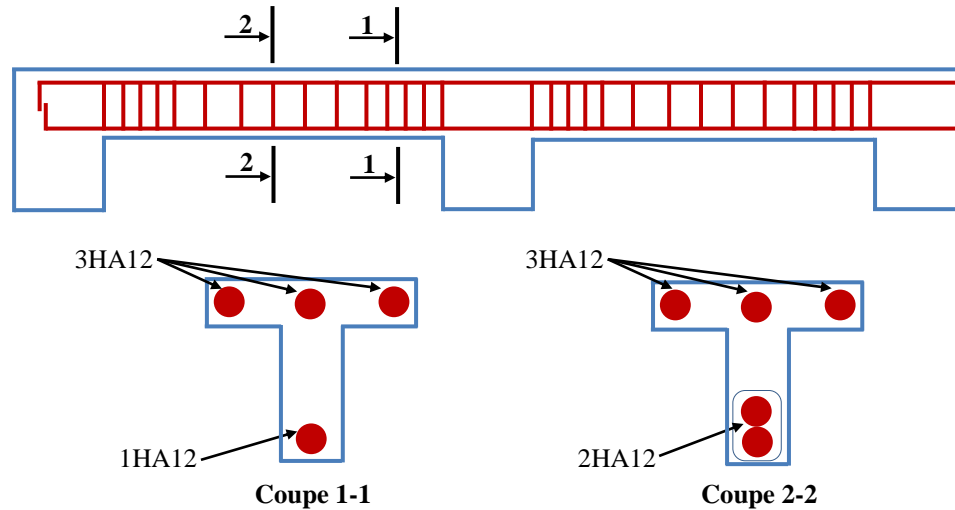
Schéma de ferrailage des poutrelles à corps creux.
